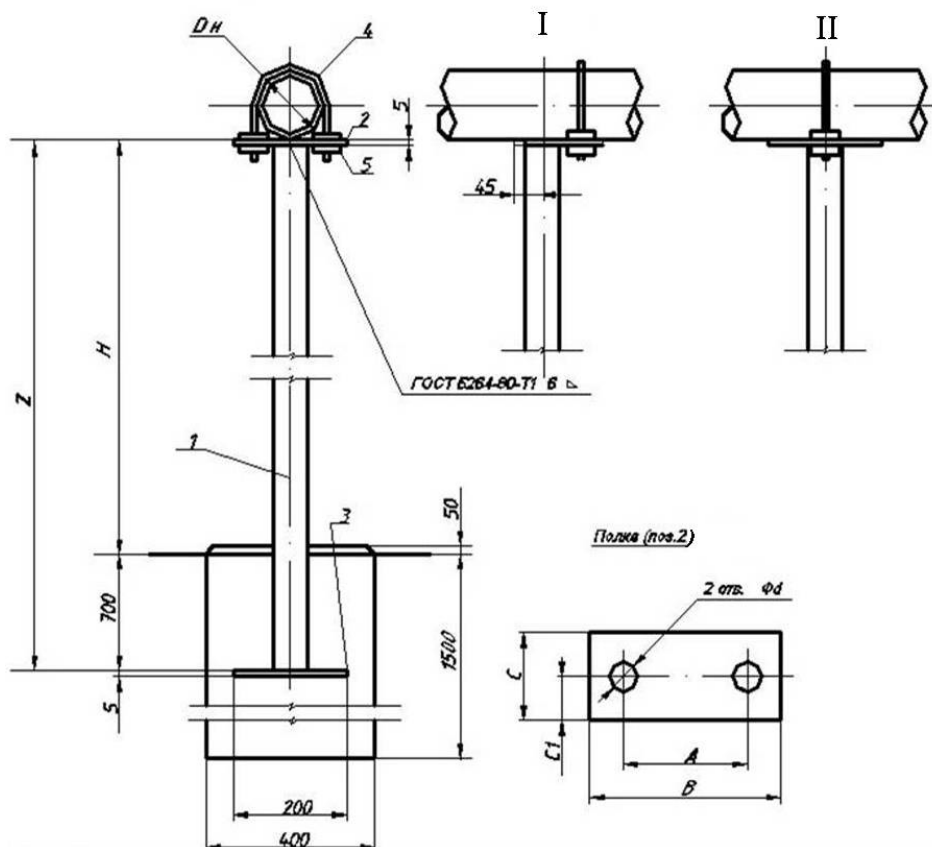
Крепление газопровода на опоре: I – газопровод Ду32; II – газопровод Ду65
